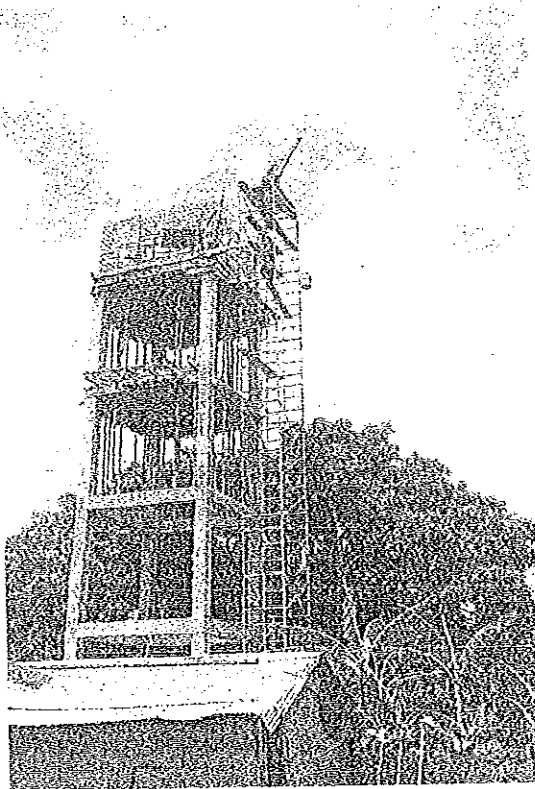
estructura completa de columnas y vigas en concreto reforzado terminado.
